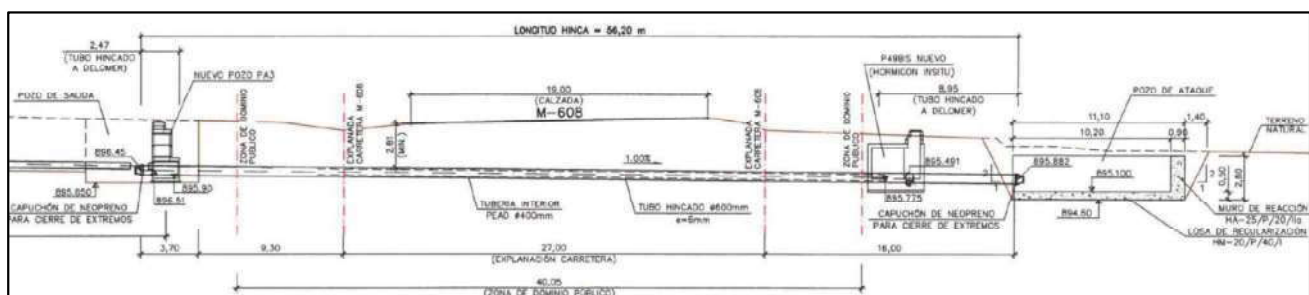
Perfil longitudinal por el eje de la tubería (tomado del plano 5.3. de Proyecto).
